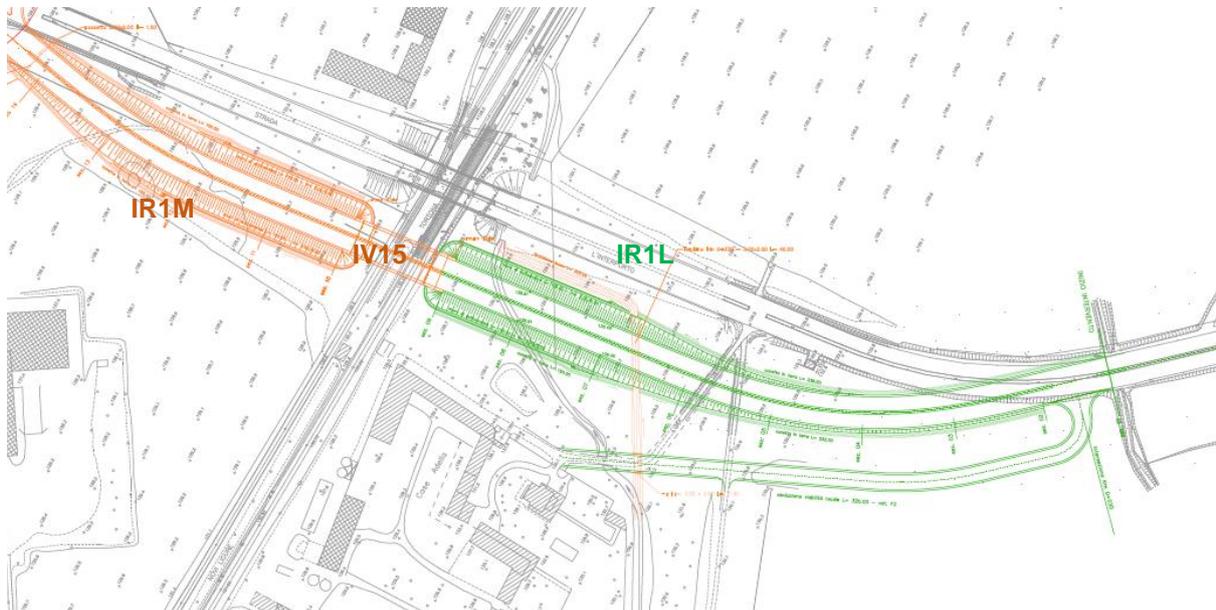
Localizzazione della rampa di approccio IR1L nel progetto approvato (in colore verde)
